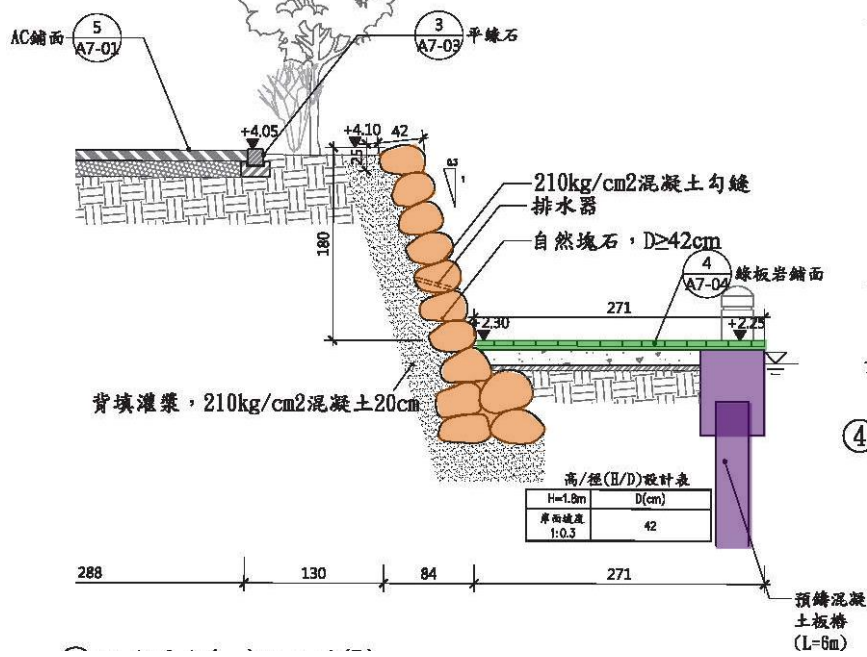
重力式擋土牆修正為預鑄混凝土版樁剖面圖
